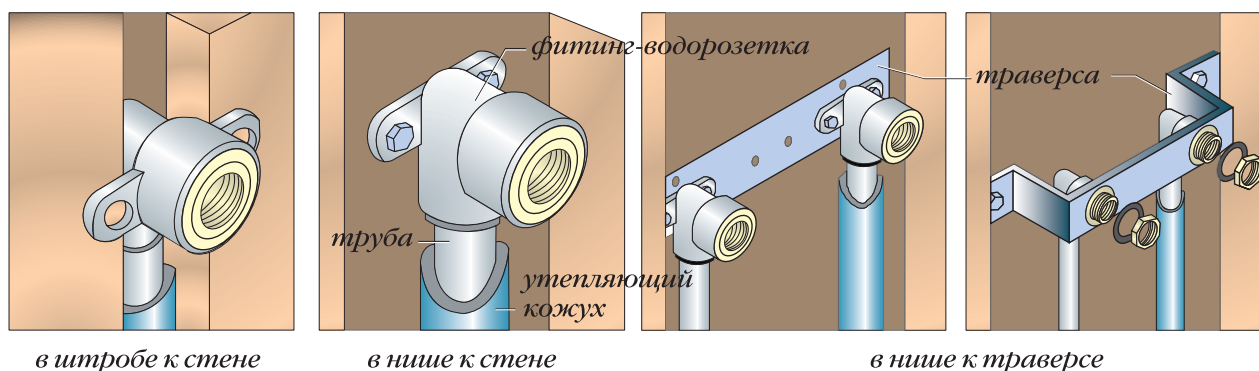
Крепление водорозеток к кирпичным, каменным и деревянным стенам
